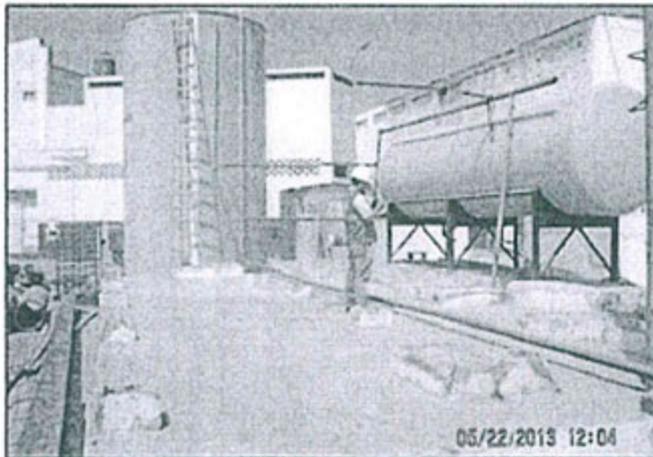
Vista del área donde estaba instalada la planta evaporadora.
